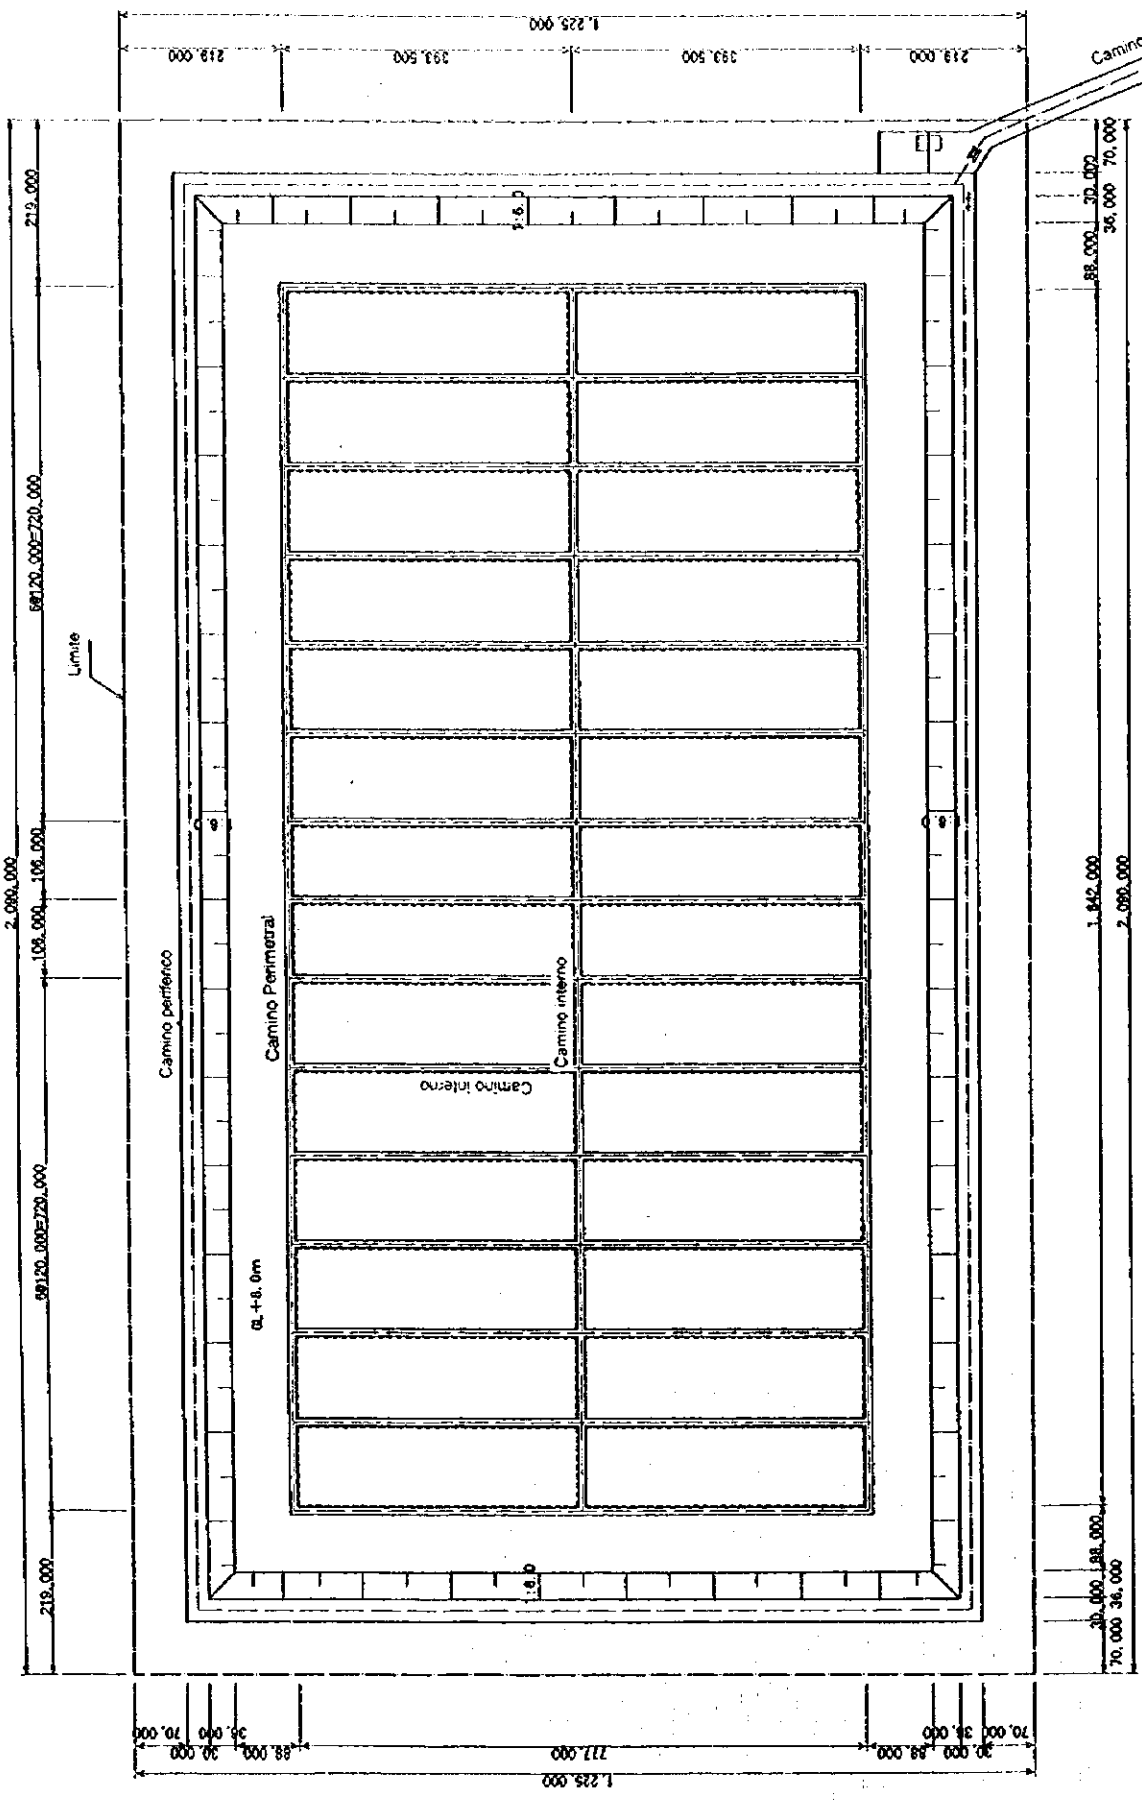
Plano de Planta del Segundo Nivel (8 m. de elevación)
